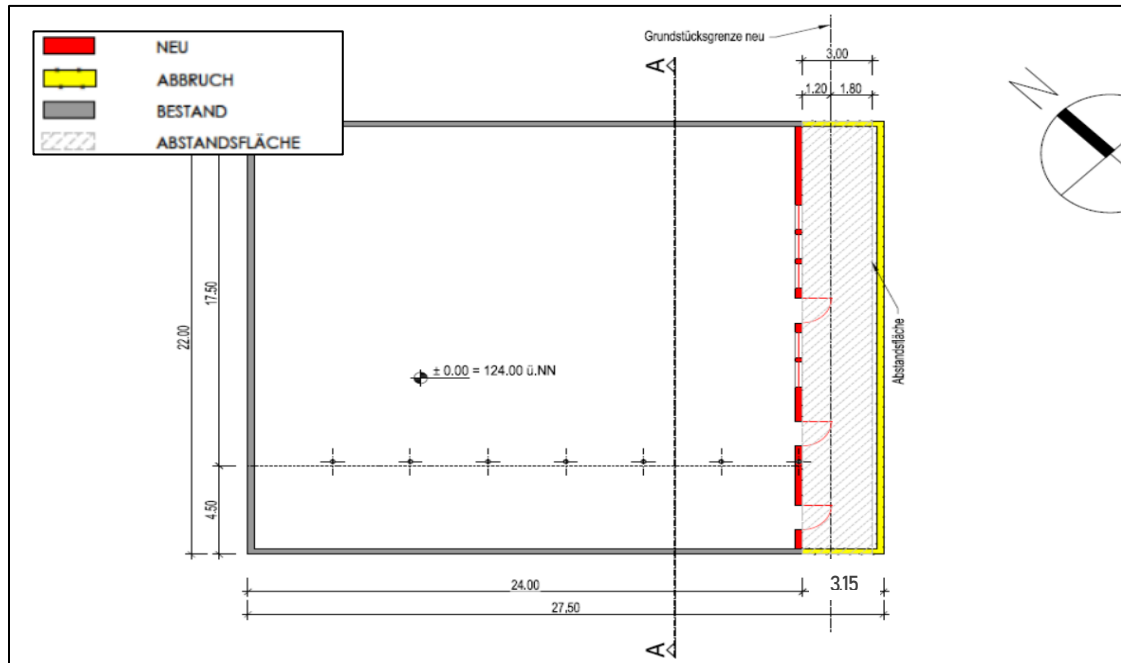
Geplanter Rückbau und Wiederaufbau der südöstlichen Außenwand der benachbarten Scheune (Quelle: Scalaplan Hamburg, Stand 07/2019)
